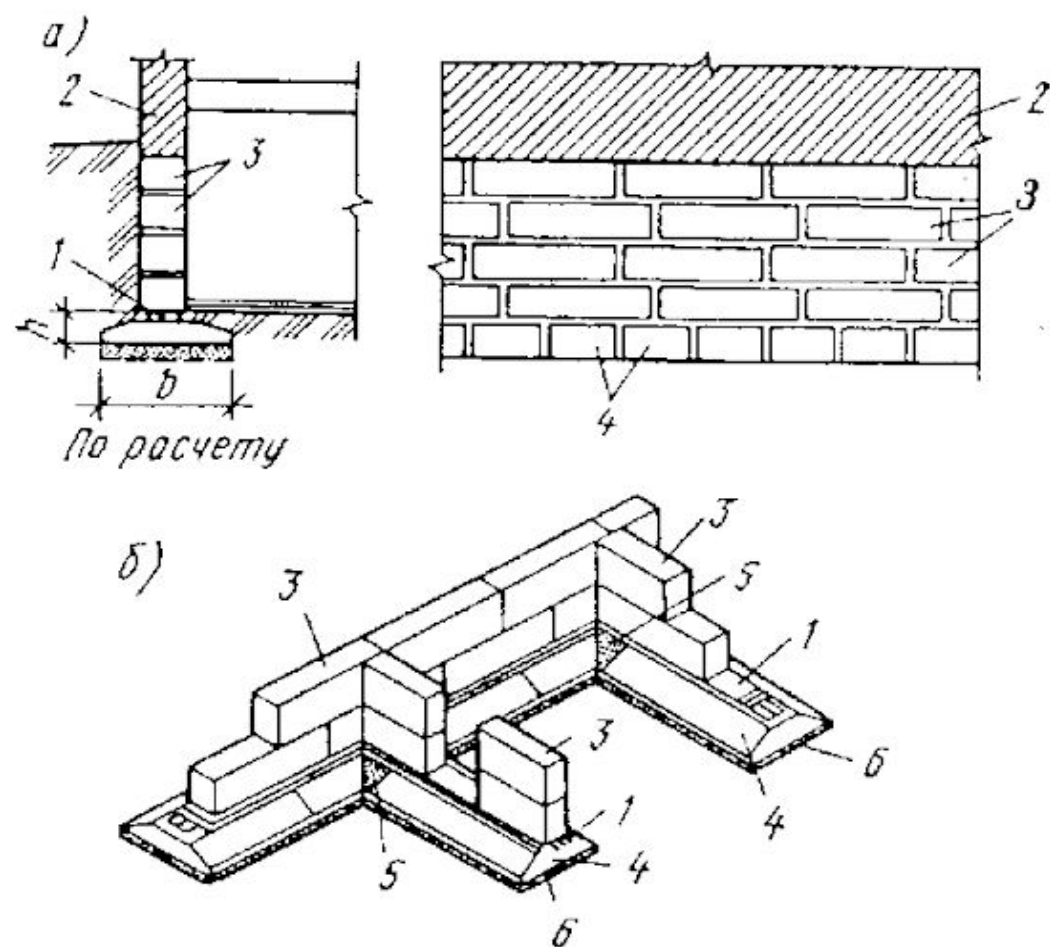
Ленточный сборный фундамент из крупных блоков:
